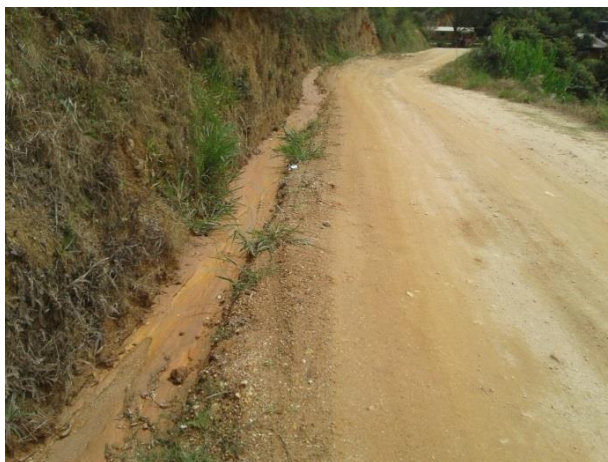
Tramo que requiere sistema de drenaje transversal, Alcantarilla (Tramo: PR22+750-PR22+850).
